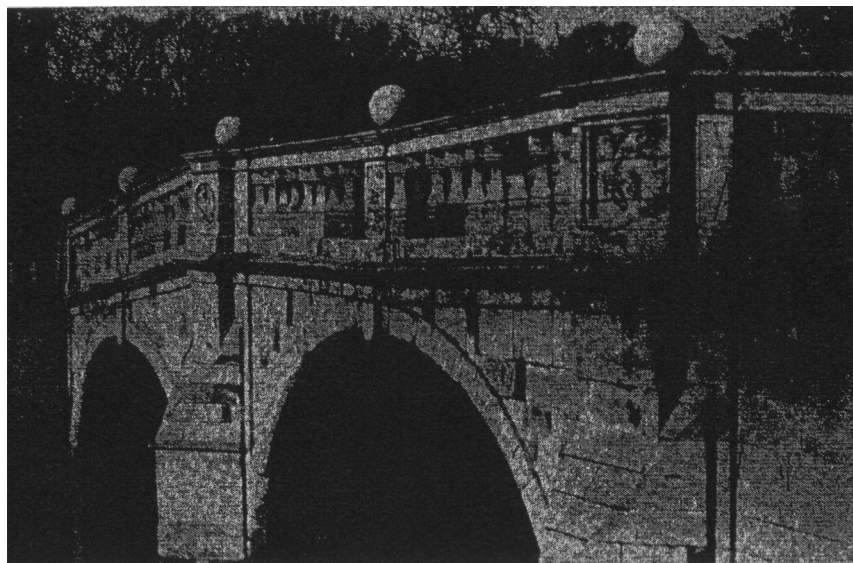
Clare College Bridge, Cambridge; Thomas Grumbold, 1638-40. On remarque le fléchissement au sommet (crown) de la travée principale.
